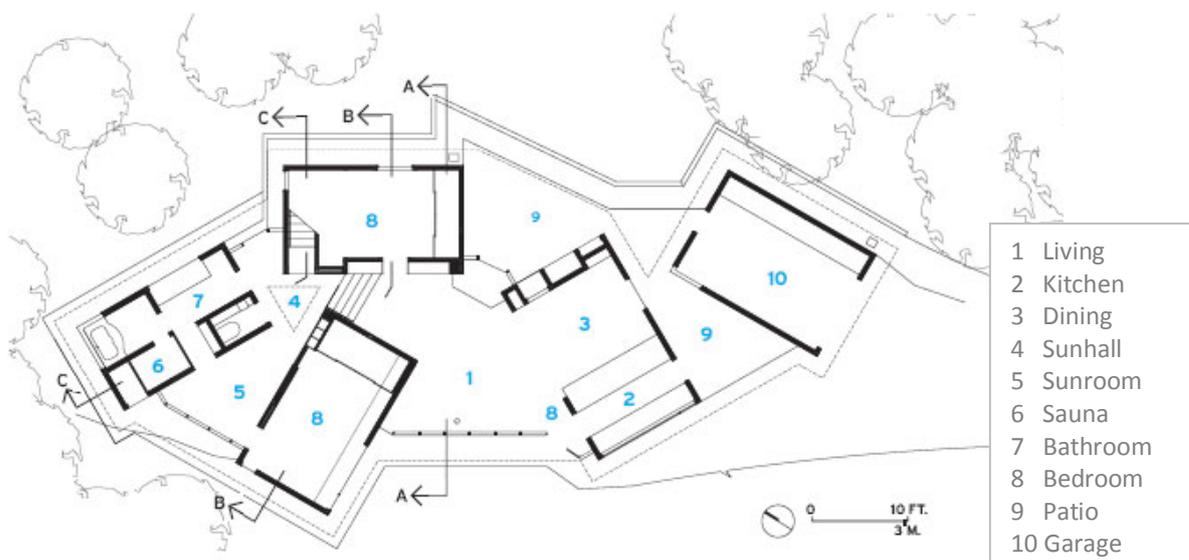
InBetween House, Grundriss, Quelle: www.kf-aa.com
